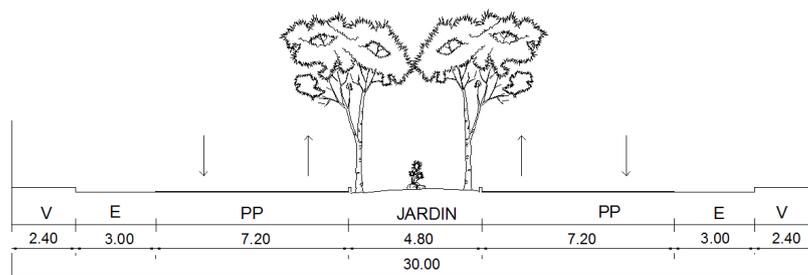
Sección vial de la avenida Los Molles colindante con el terreno del proyecto.
